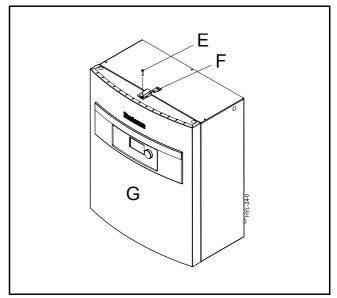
Rimontaggio involucro del modulo idraulico interno AW
